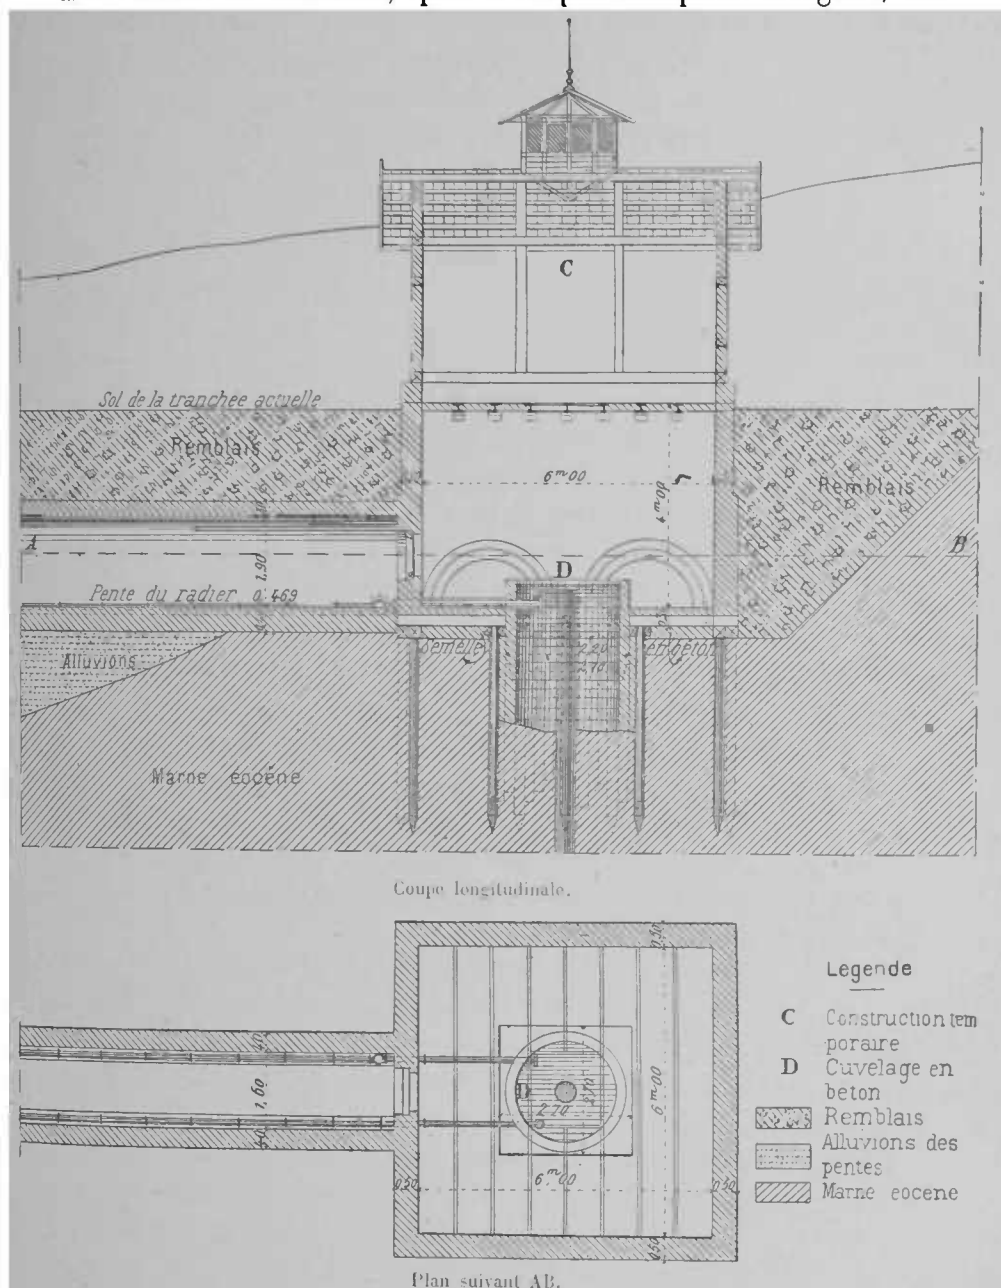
et 70. — Geleznovodsk ; sous-groupe de l'Est. Travaux de recherches et d'aménagement de la source Giaznouchka supérieure. Coupe longitudinale et plan suivant AB (d'après M. Dru).
